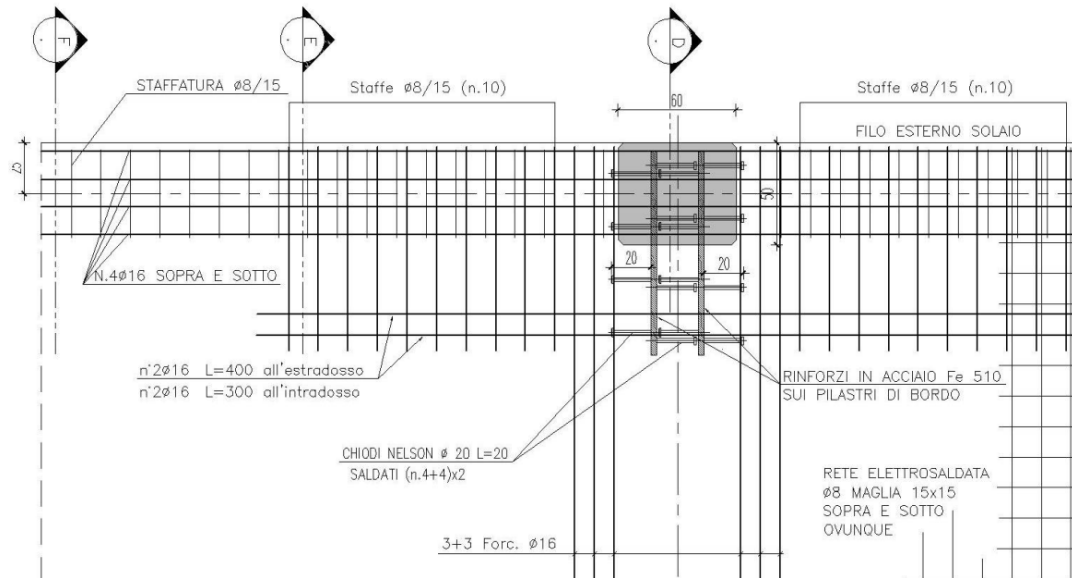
Stralcio pianta di armatura pilastro di bordo del quarto piano
